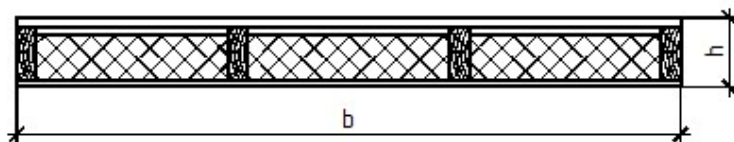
Поперечное сечение клефанерной плиты покрытия
